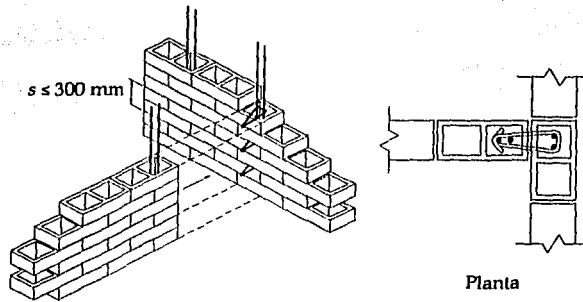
Conectores entre muros sin traslape de piezas.
